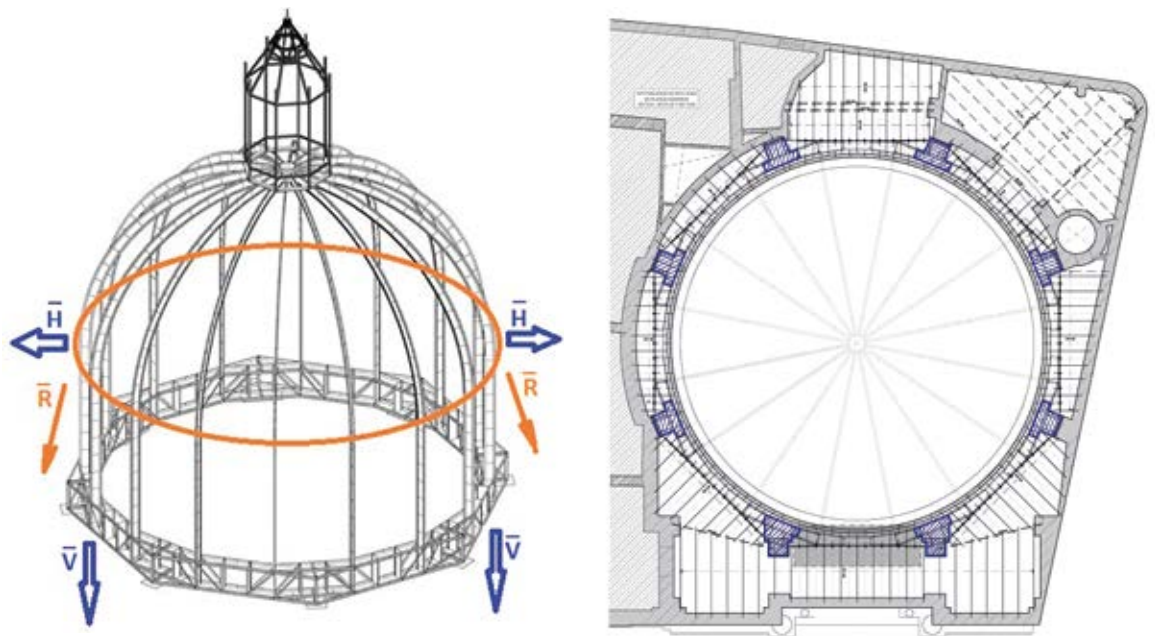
Armazón de la estructura metálica nervada de tambor y cúpula, empotrados los nervios entre la doble viga triangulada que descansa sobre los machones de fábrica de ladrillo que mostramos en la planta de la derecha, a la vez que se muestra la estructura de viguetas metálicas que soportan los forjados que horizontalmente encastran al nivel superior de las vigas trianguladas. Se puede apreciar como las viguetas tienden a entregarse perpendiculares a los lados del octógono entre pilastras. La estructura de la linterna que gravita sobre el anillo de compresiones de la cúpula es de la rehabilitación de 1995. (De los Proyectos de los autores)
